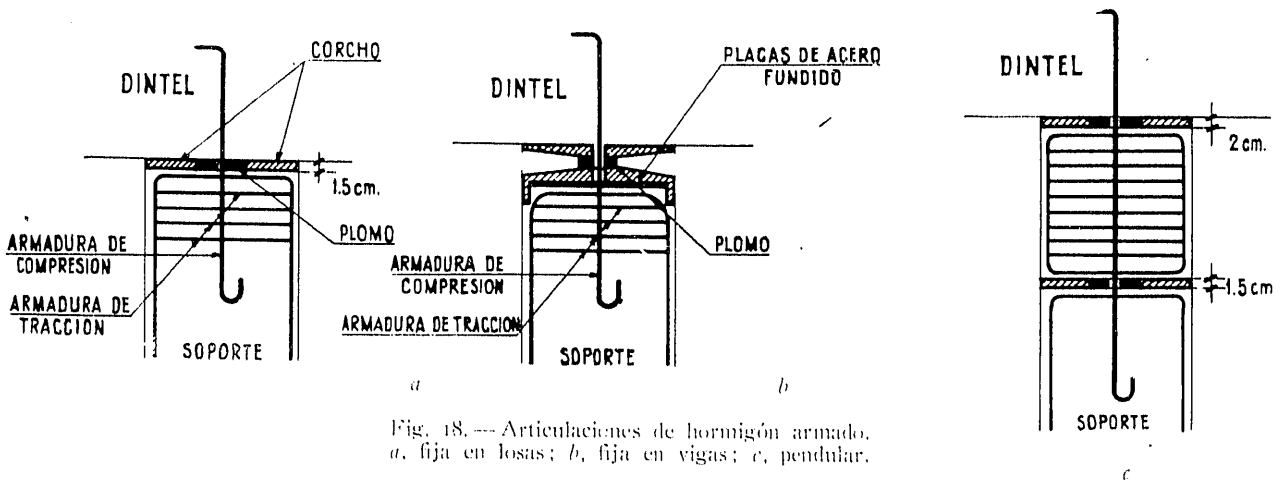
Articulaciones de hormigón armado. *a*, fija en losas; *b*, fija en vigas; *c*, pendular.
